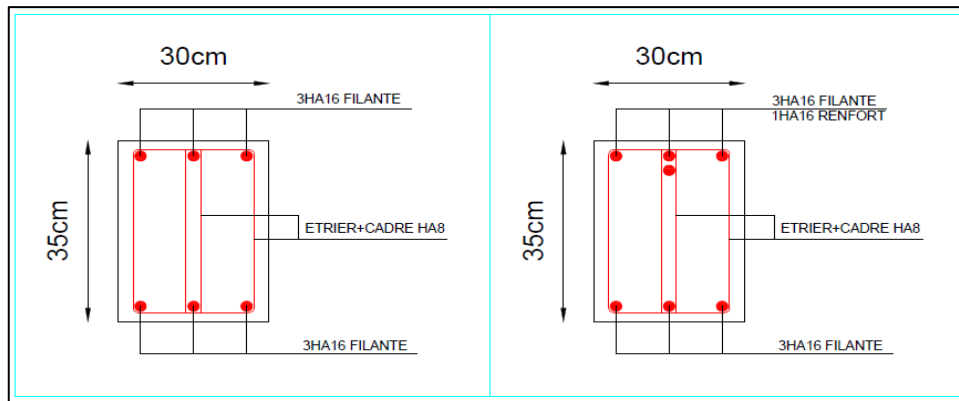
Ferrailage des poutres secondaires (35×30) cm selon le calcul à L'E.L.ACC
